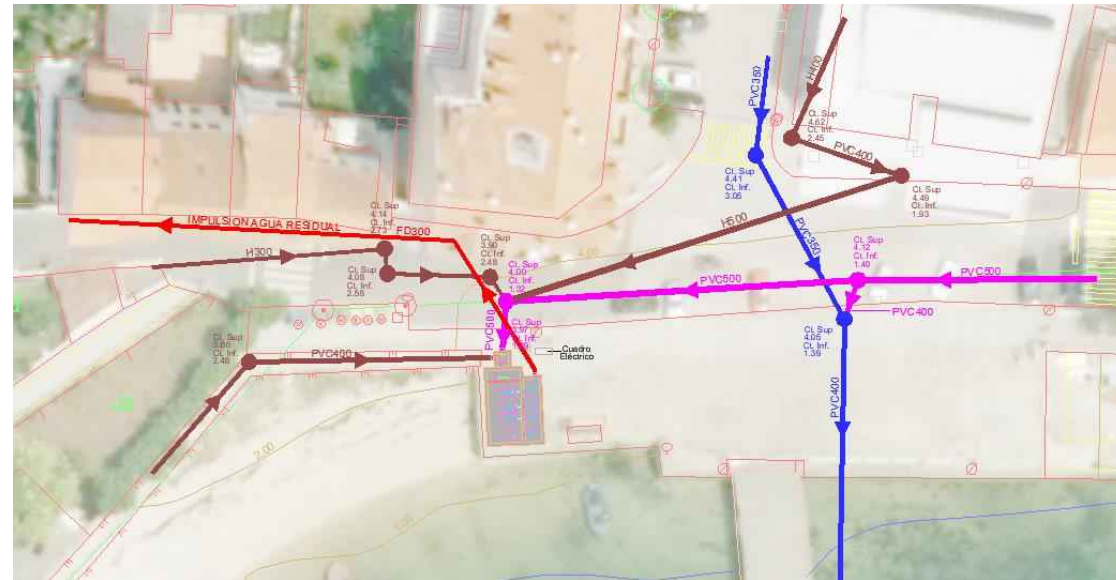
EBAR Concello. Planta general conexiones hidráulicas
